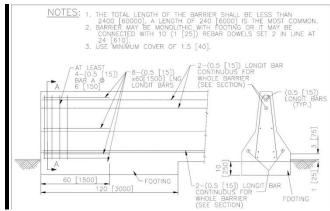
Plano constructivo barrera Tipo F. Fuente: FHWA, 2011
